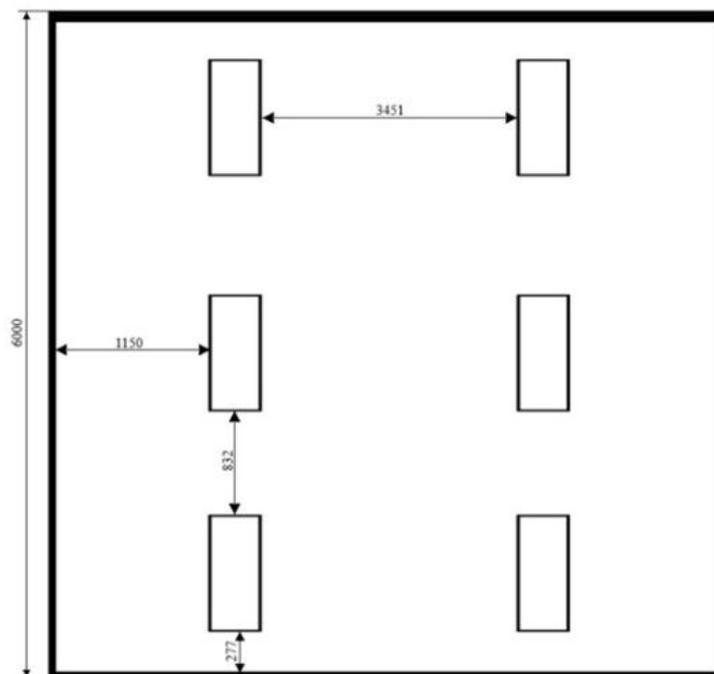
План помещения и размещения светильников со светодиодными лентами
